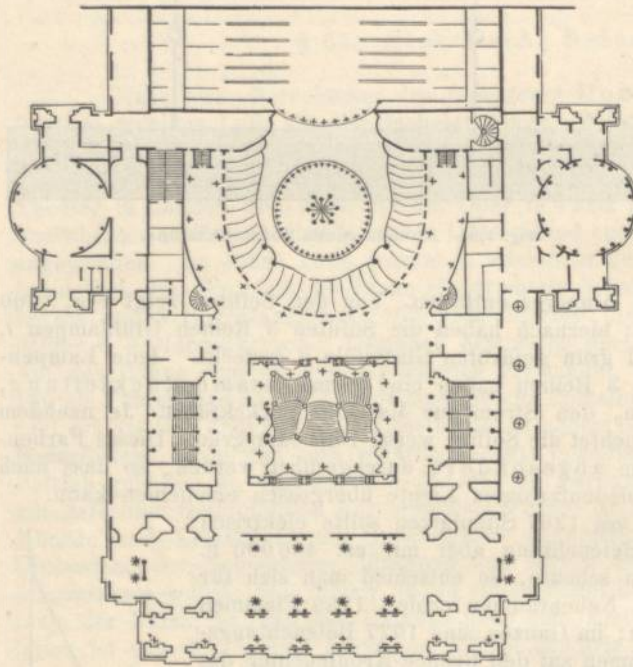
Elektrische Probebeleuchtung der Oper in Paris.
